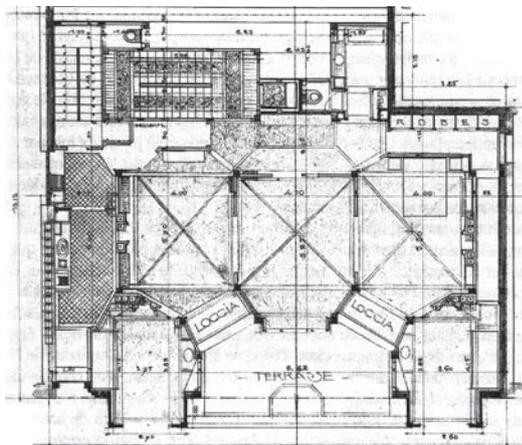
Planta baixa do térreo. (ABRAM, 2002, p.220).
